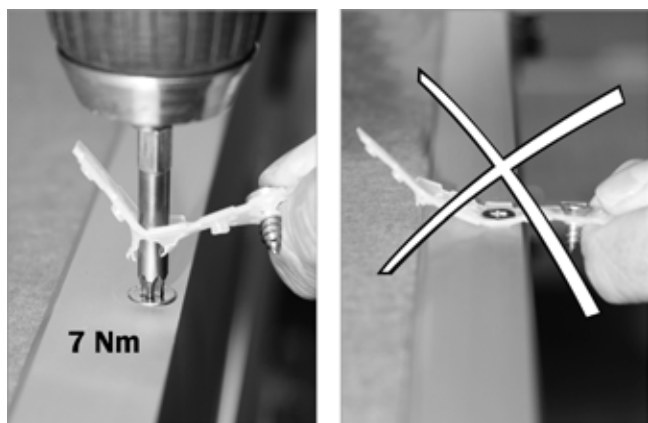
Schraube eindrehen (Gurt nicht mit eindrehen)
